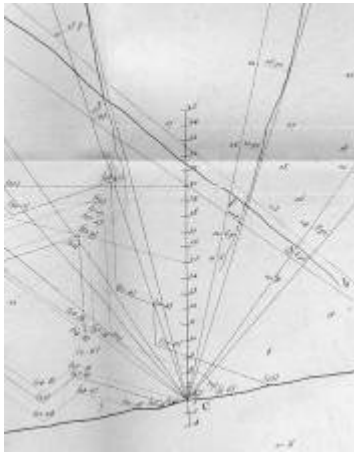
Lehrbuchmäßiger Kottierungsplan [Höhenplan] nach Bousmard, 1814, Pl. 50. Entlang der strahlenförmig von A und B ausgehenden Linien ist das Höhenprofil (Relief) mit Distanzen in Toisen eingezeichnet. Die eigentlichen Höhen über dem Bauhorizont des Brückenkopfs sind in Klammern () angegeben.
